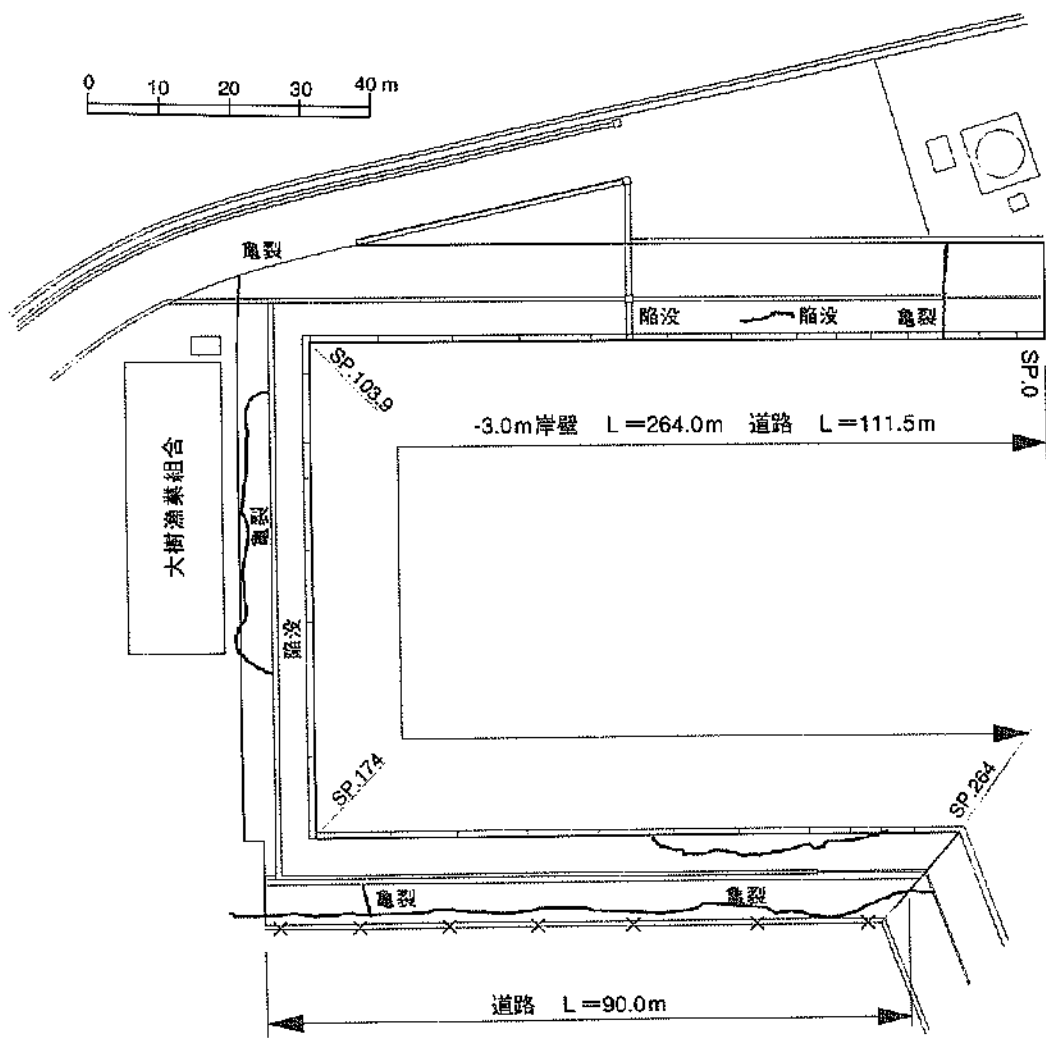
大樹漁港⑧-3.0m岸壁および道路被災状況平面図
